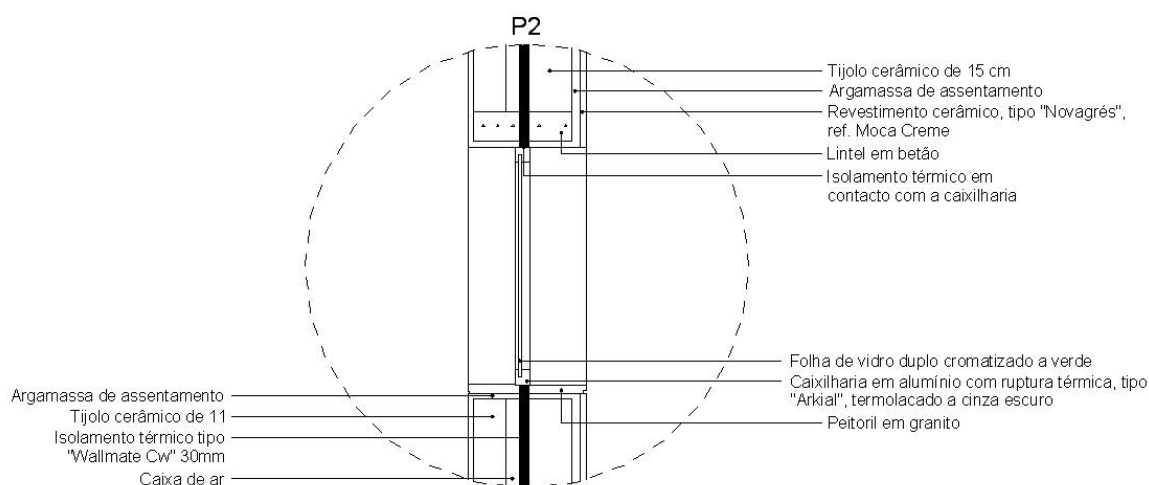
Pormenor da Parede Exterior com Pontes Térmicas Planas corrigidas
